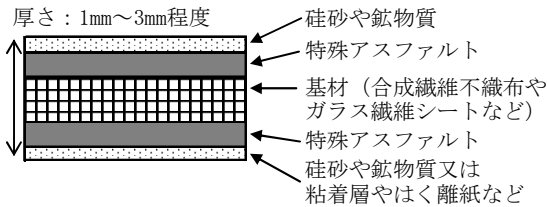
ひび割れ抑制シートの断面概要図
